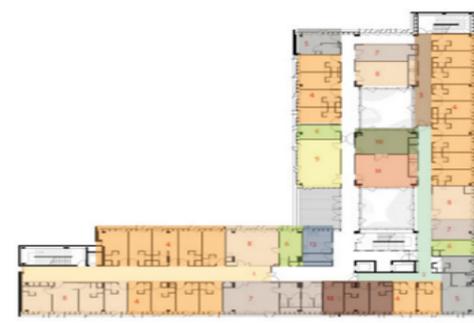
Planta arquitectónica. Fuente: Plataforma arquitectura, 2016.
